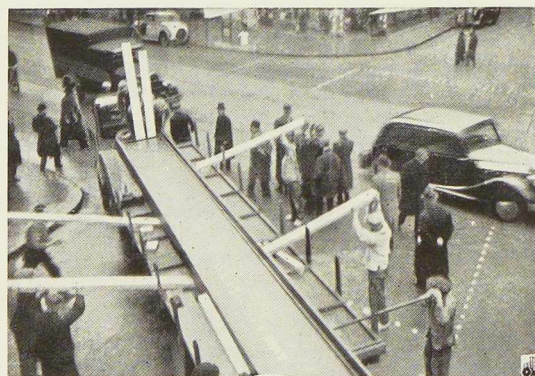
Déchargement d'une poutrelle DIN 100, de 13 mètres de longueur.
